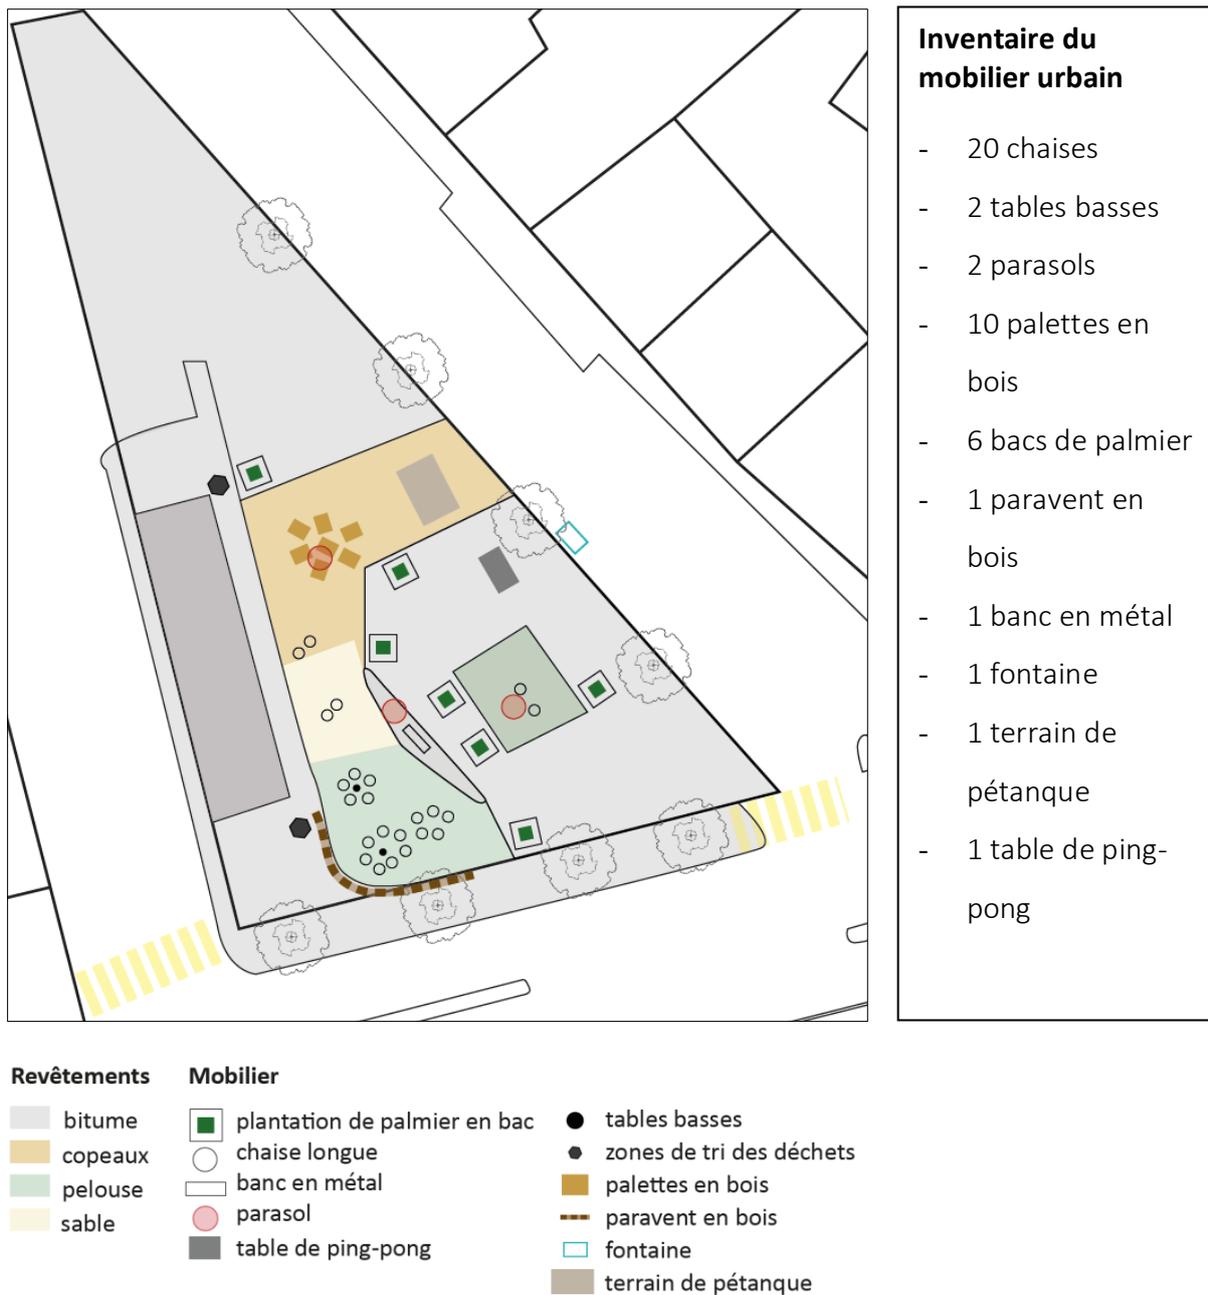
Implantation du mobilier urbain sur la place du Tunnel. Source : Virnot, 2022
